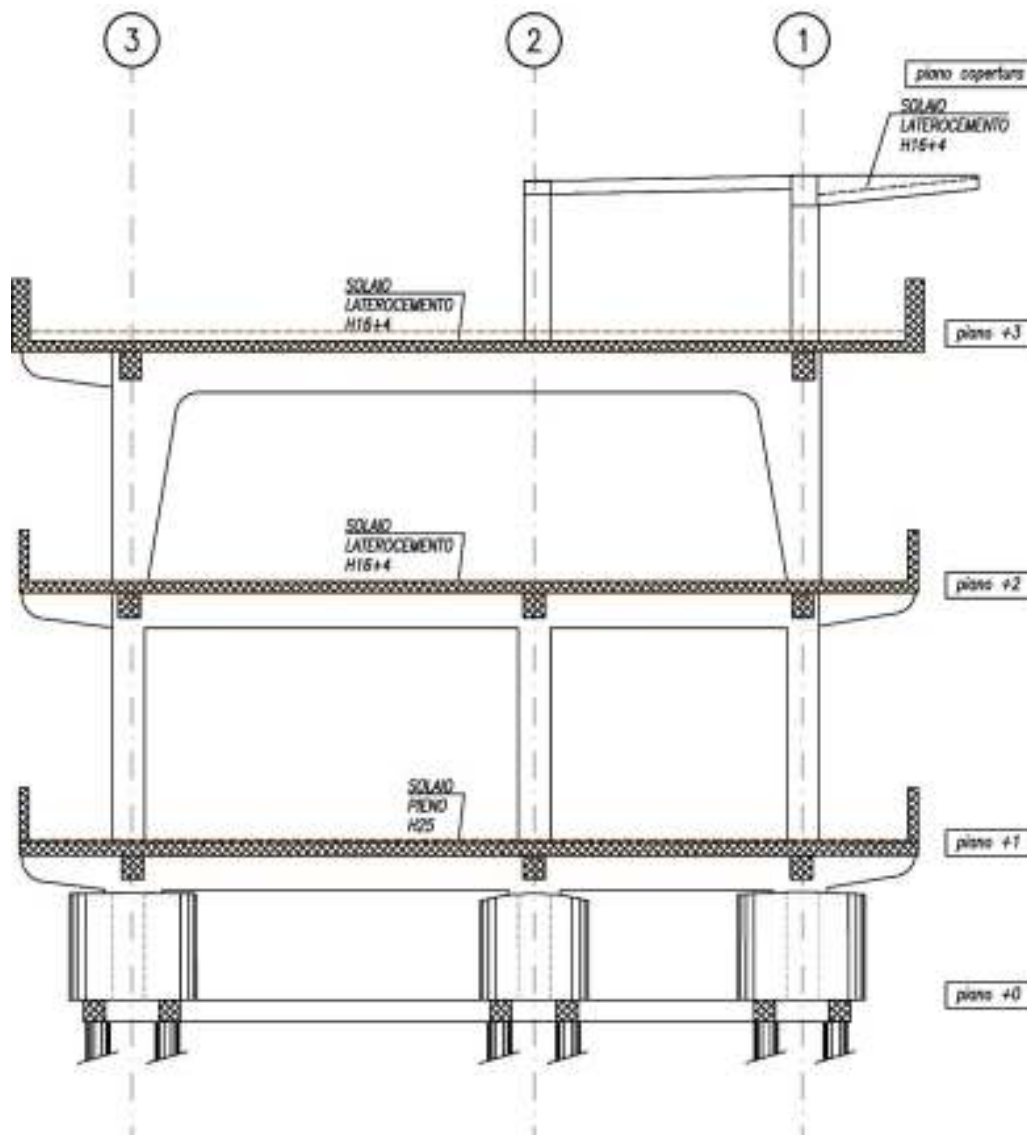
Colonia marina Dux. Sezione edificio con nomenclatura degli orizzontamenti
